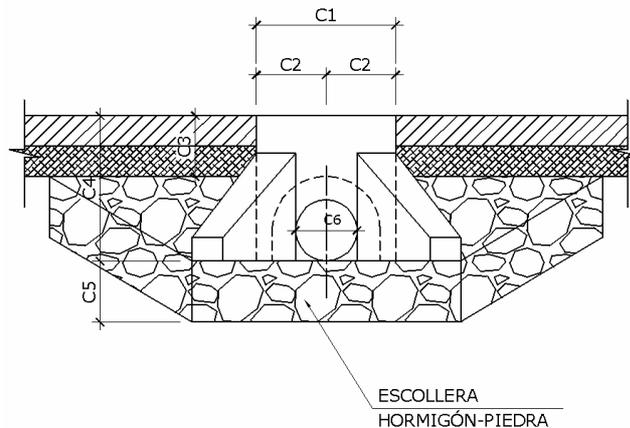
Alzado de ODT en su salida con embocadura de aleta y escollera de piedra.
